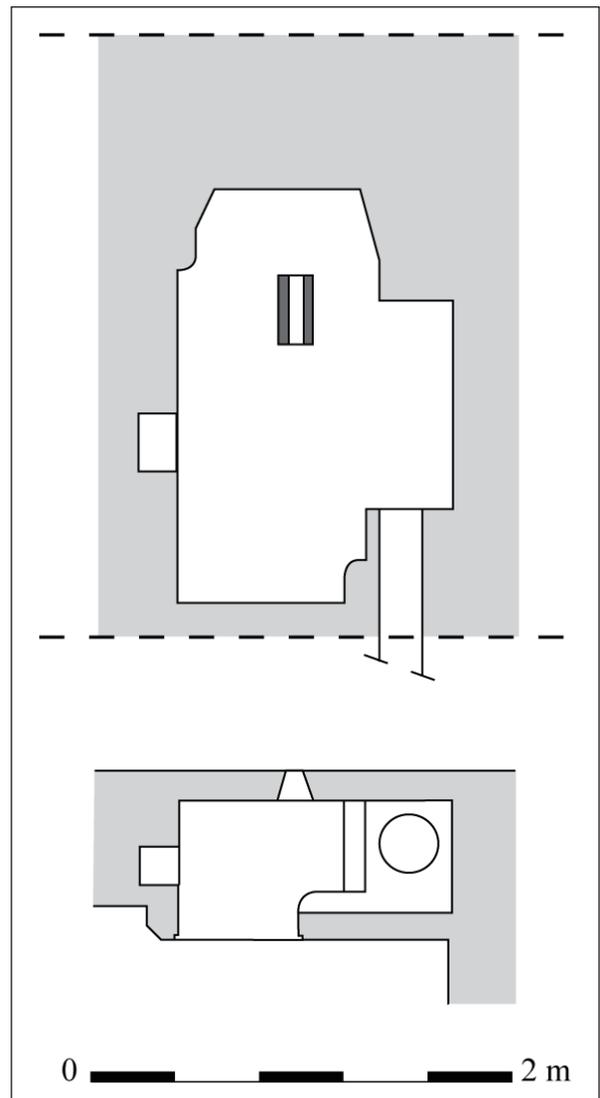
coupe et plan des latrines placée dans le mur ouest, au deuxième étage
